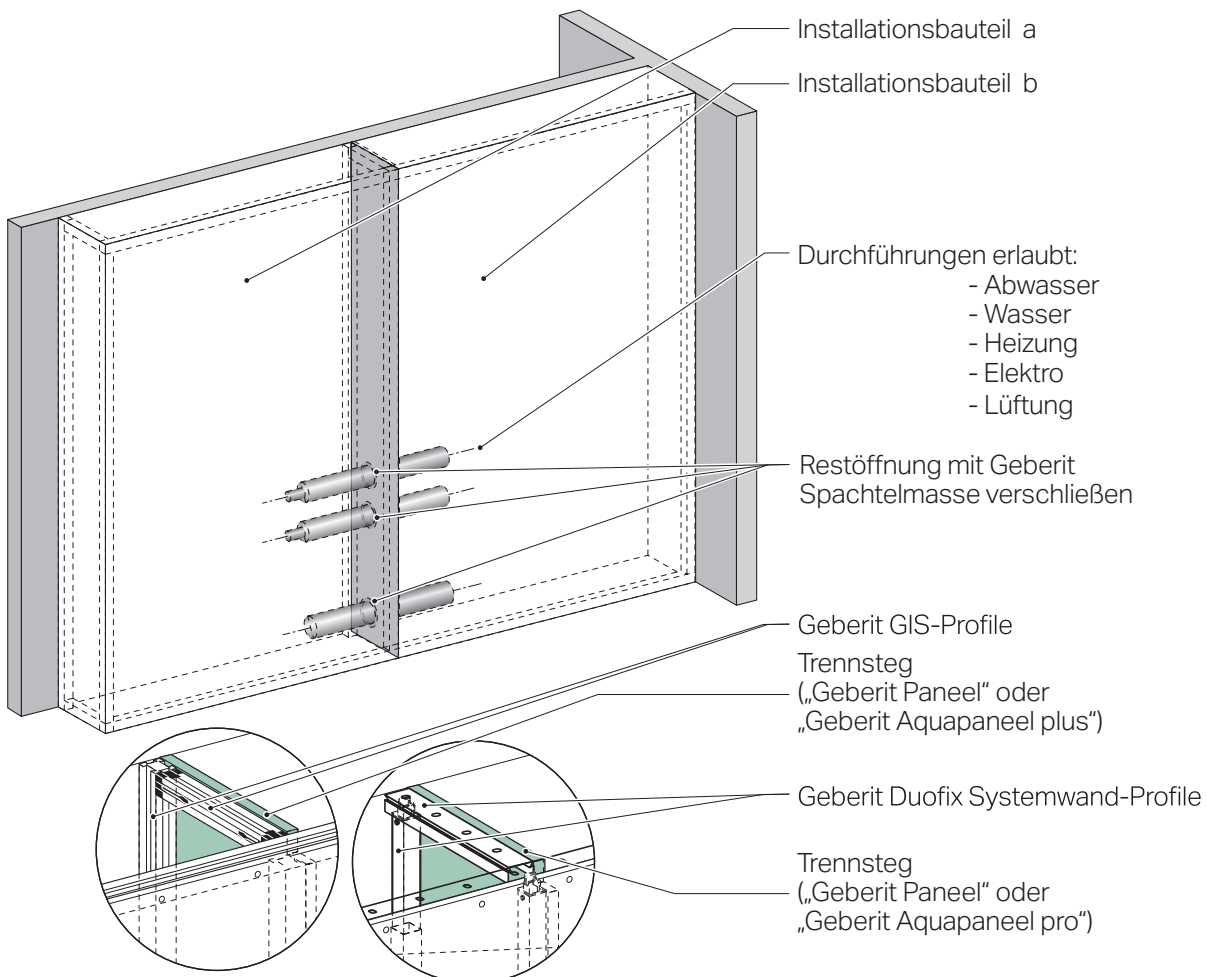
Ausbildung Trennsteg bei Schachtbreiten über 2 m mit Rohrdurchführungen ohne klassifizierte Rohrschottungen
